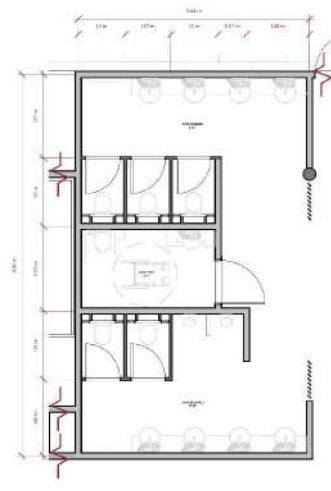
Detalle baños de trabajadores. Fuente: Elaboración propia
